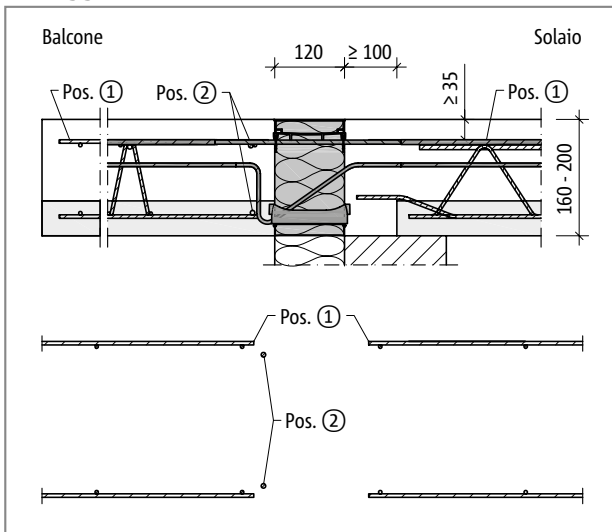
Schöck Isokorb® tipo KFXT: armatura in opera con spessore del balcone $h = 160 - 200$ mm
